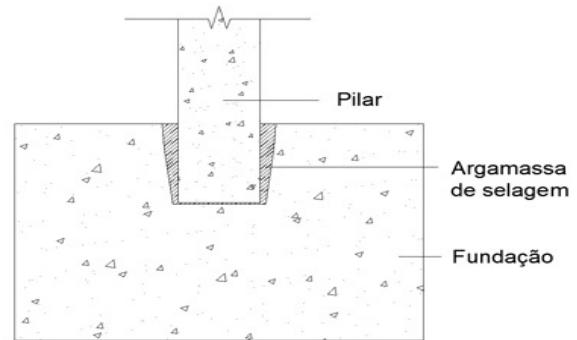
Ligação por meio de cálice em sapata betonada em obra
